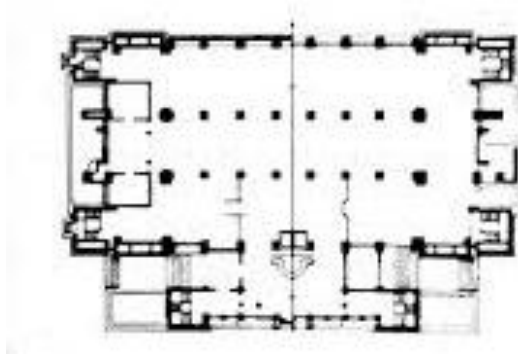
| Larkin - Planta Térreo | Miquel Gregori
